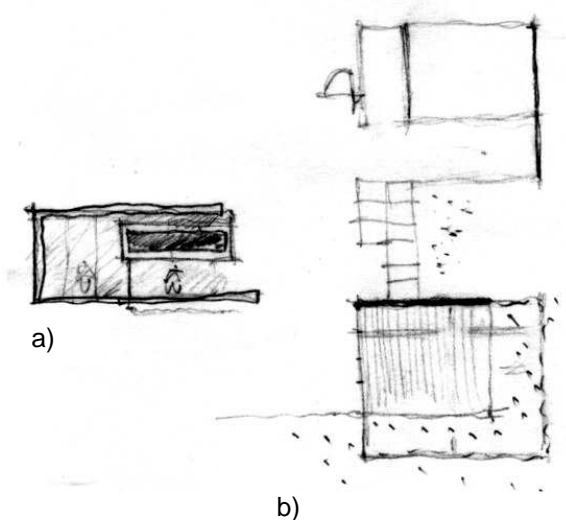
Planta e elevação com varanda ao lado da sala e sob os quartos
